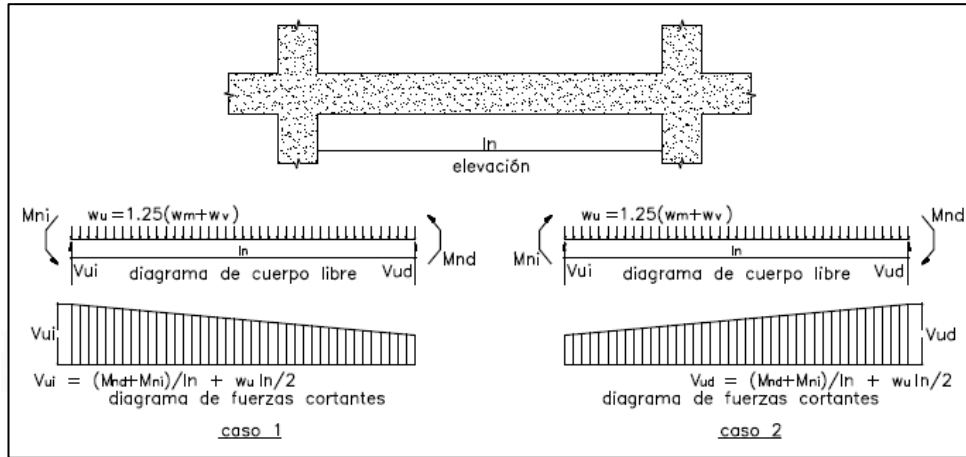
Esquema de diseño por capacidad para vigas.
